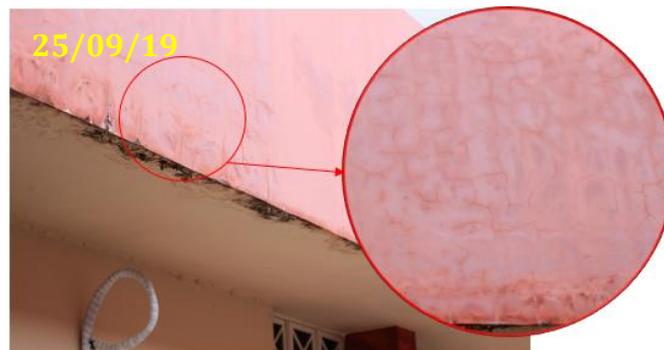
Fissuras na platibanda do Anexo do Centro de Ciências e Tecnologia/UFRR, campus Paricarana.
